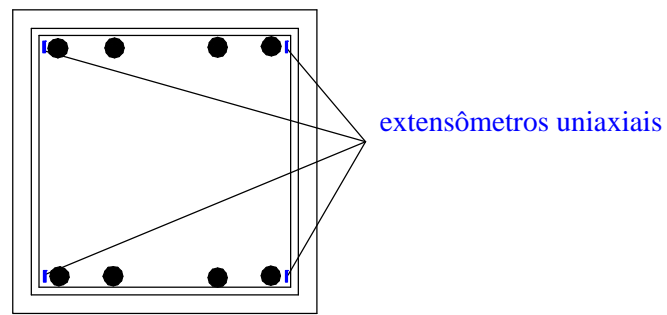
Posicionamento dos extensômetros na seção transversal da viga.
